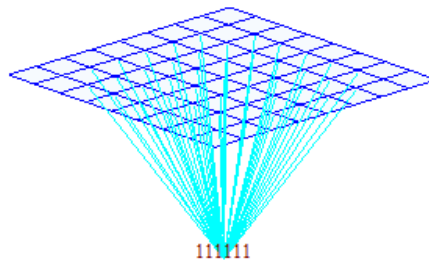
Vista prospettica estrusa del modello della spalla A
